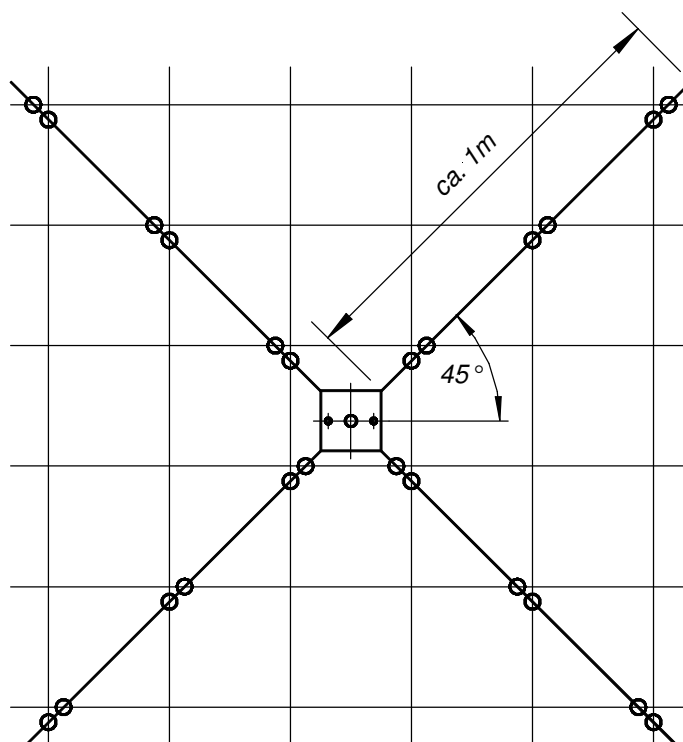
Dispersore di fondazione a forma di croce: punto di connessione ZS per il collegamento equipotenziale di protezione, disposizione asimmetrica
